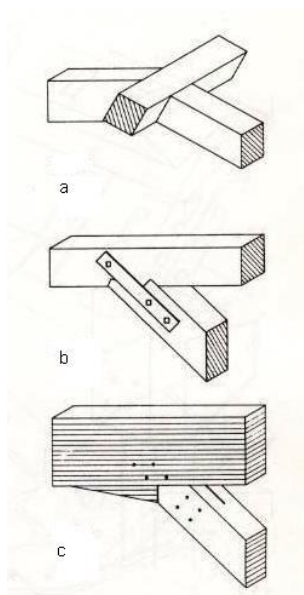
a) Ligação por entalhe; b) Ligação por chapas metálicas; c) ligação metálica/parafusos
